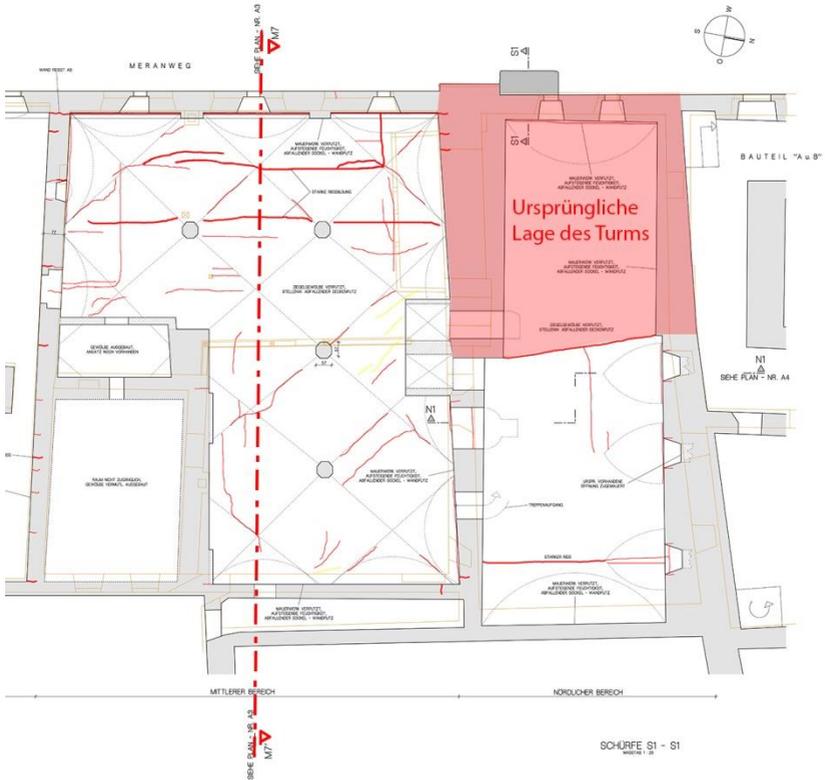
Auszug aus dem Grundriss der Höchstetterbrauerei mit den Gewölben im Anschluss an den ehemaligen Torturm des „Chamer Stadtschlusses“
